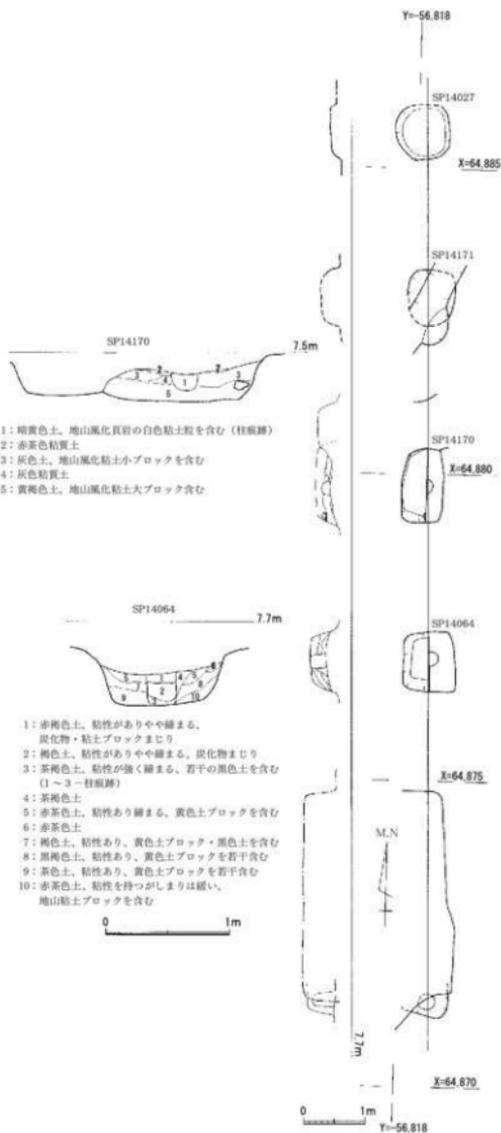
掘立柱列 SA14602 実測図 (平面図は 1/80、土層断面図は 1/40)
